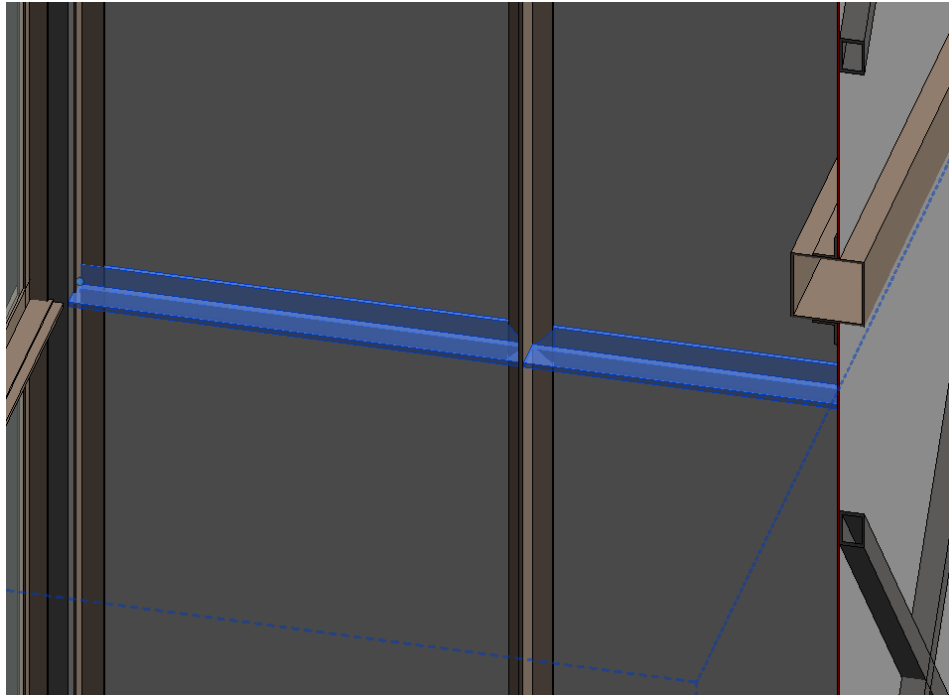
Viga TNP 90 disposta na caixa de elevadores
